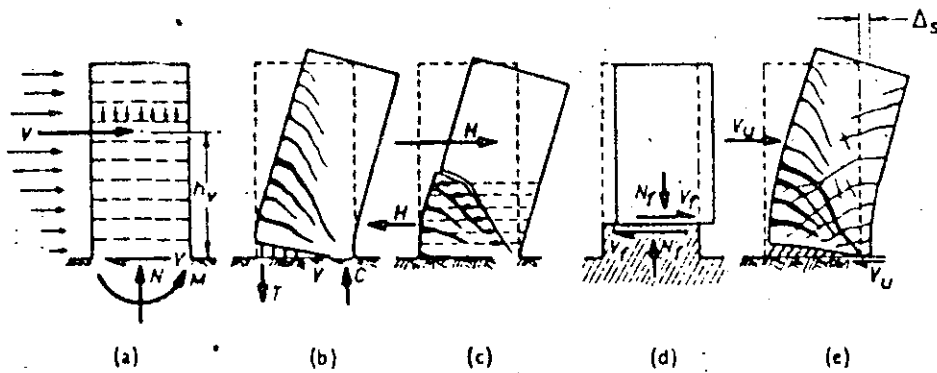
Modos de falla en un muro de cortante en voladizo, de concreto reforzado, cargado lateralmente.
